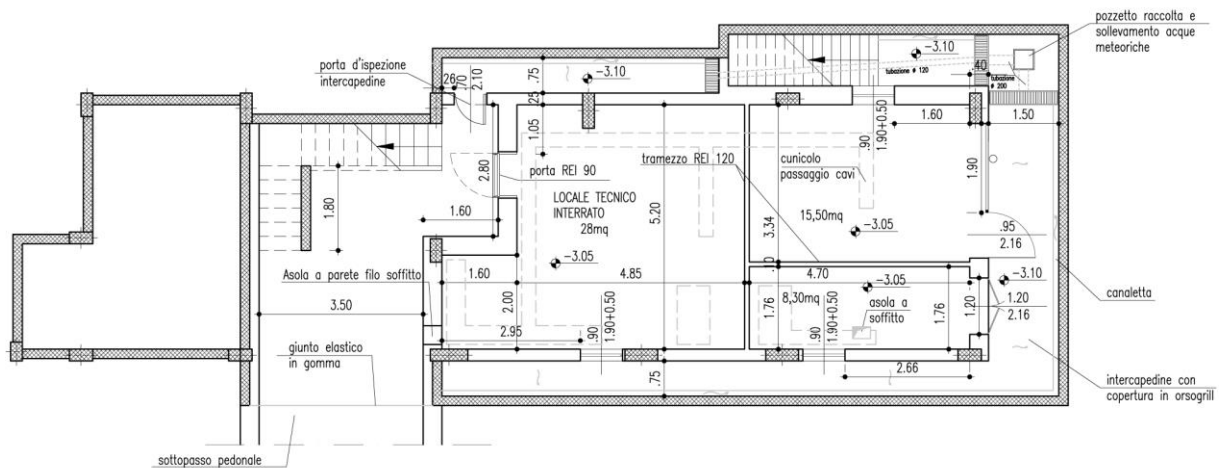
Pianta Piano Interrato Fabricato di Casello
